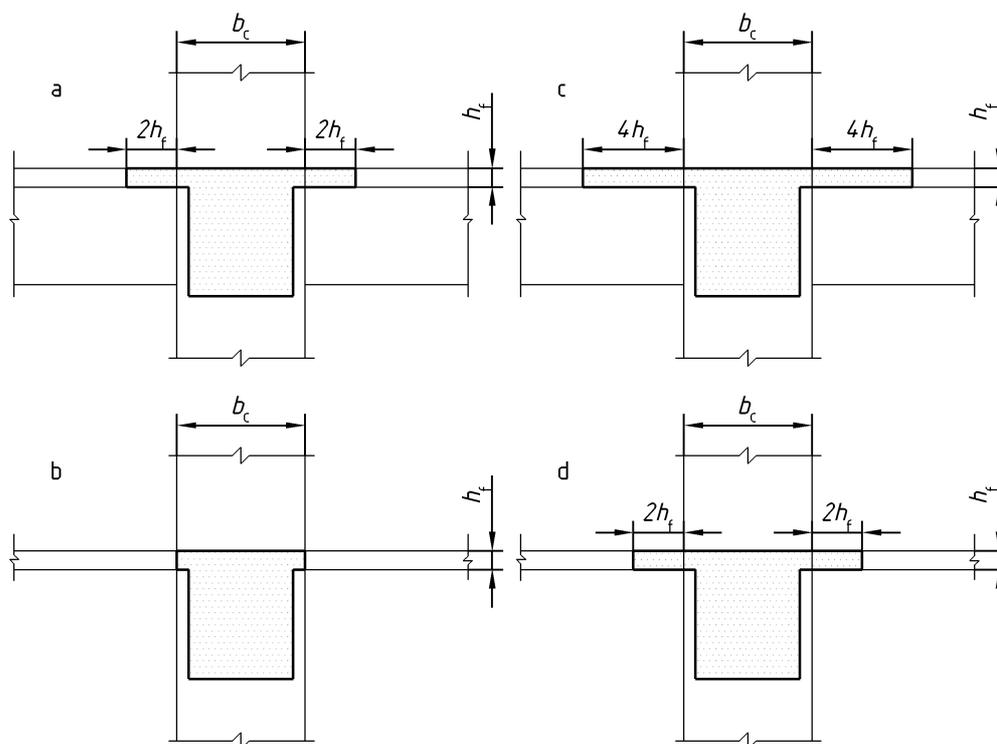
Largeur participante  $b_{\text{eff}}$  des membrures de poutres connectés aux poteaux
